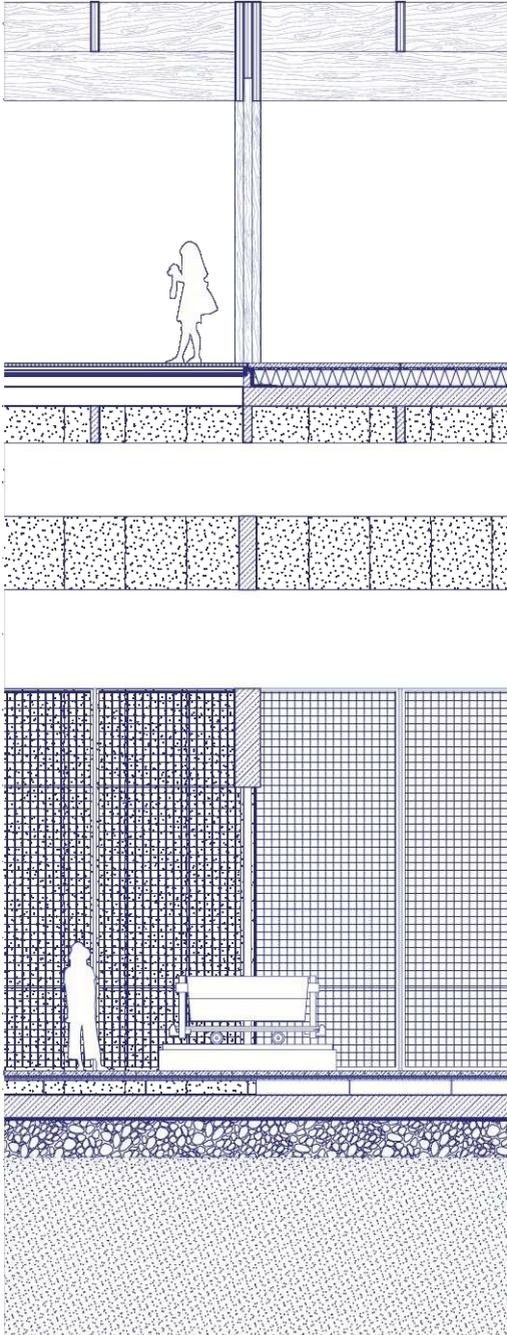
Details Längsschnitt, Teil 1, M 1:100
